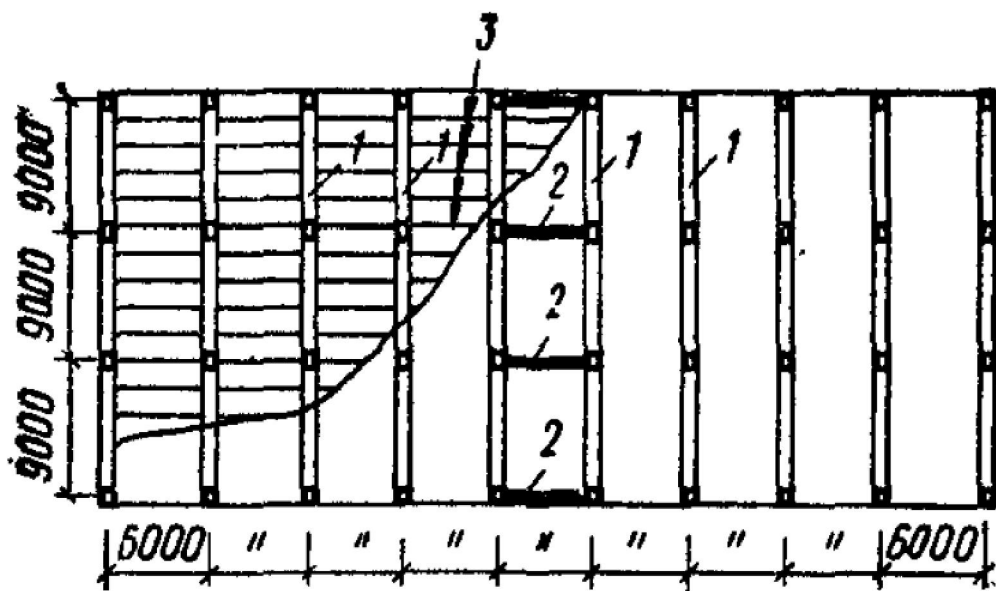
Конструктивный план многоэтажного каркасного промышленного здания (1 - поперечные рамы; 2 - продольные вертикальные связи; 3 - панели перекрытий) [1]
